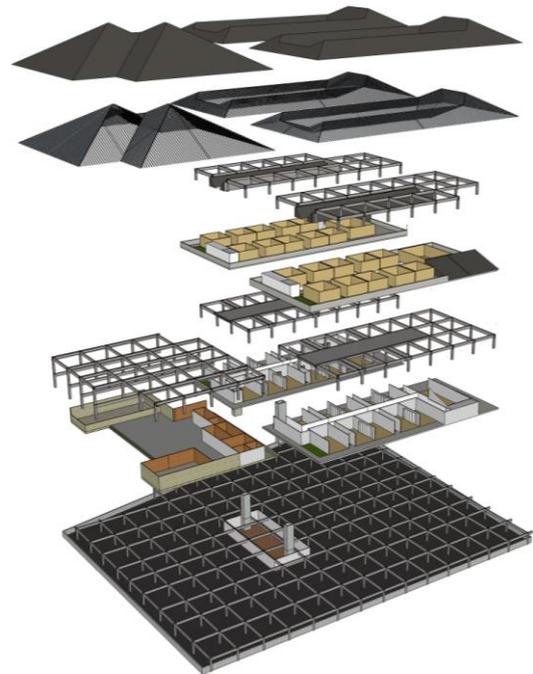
Sistem struktur rangka konstruksi beton.
